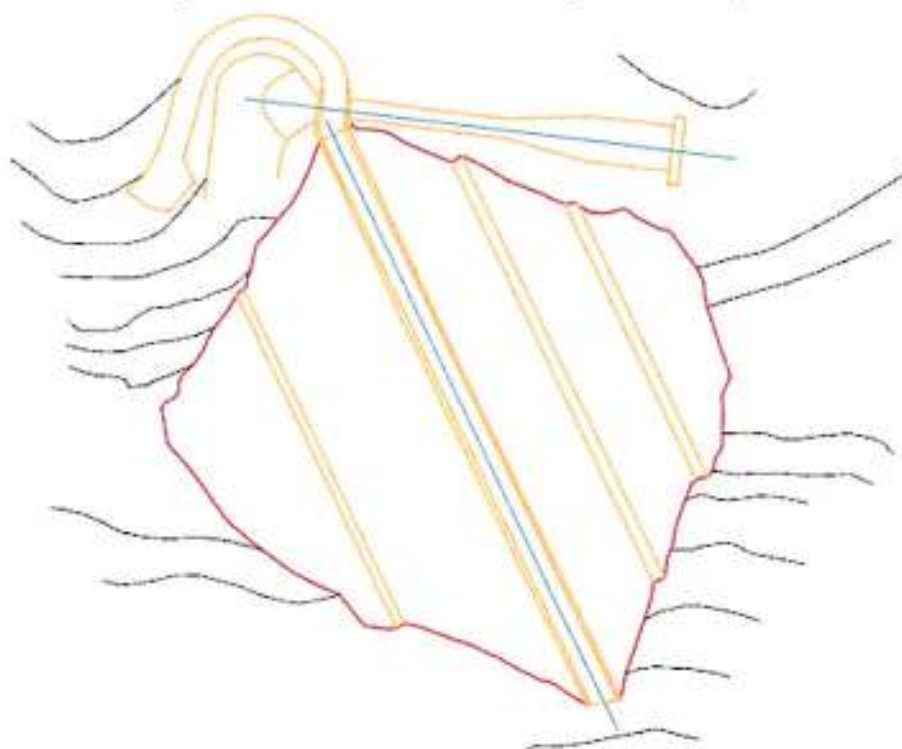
Planta da barragem do Corte Brique (Fonte: portal INAG – Barragens de Portugal)
